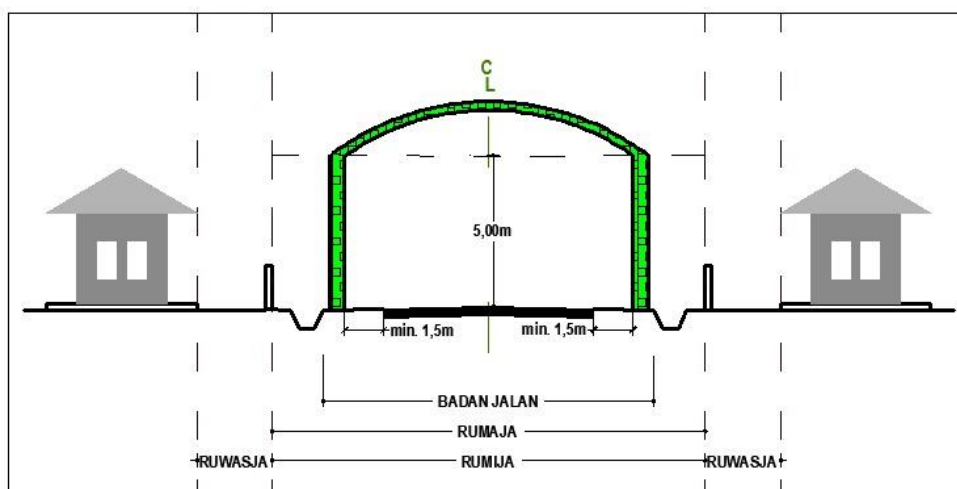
Contoh Penempatan Gapura di Ruang Milik Jalan Tipe 1
